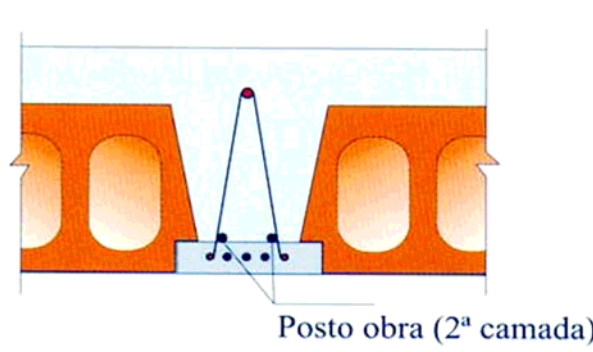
Armadura complementar de tração (LAJES FAULIM, 1998).
